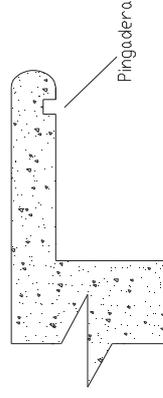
Modelo de Pingadeira para detalhes da fachada.
